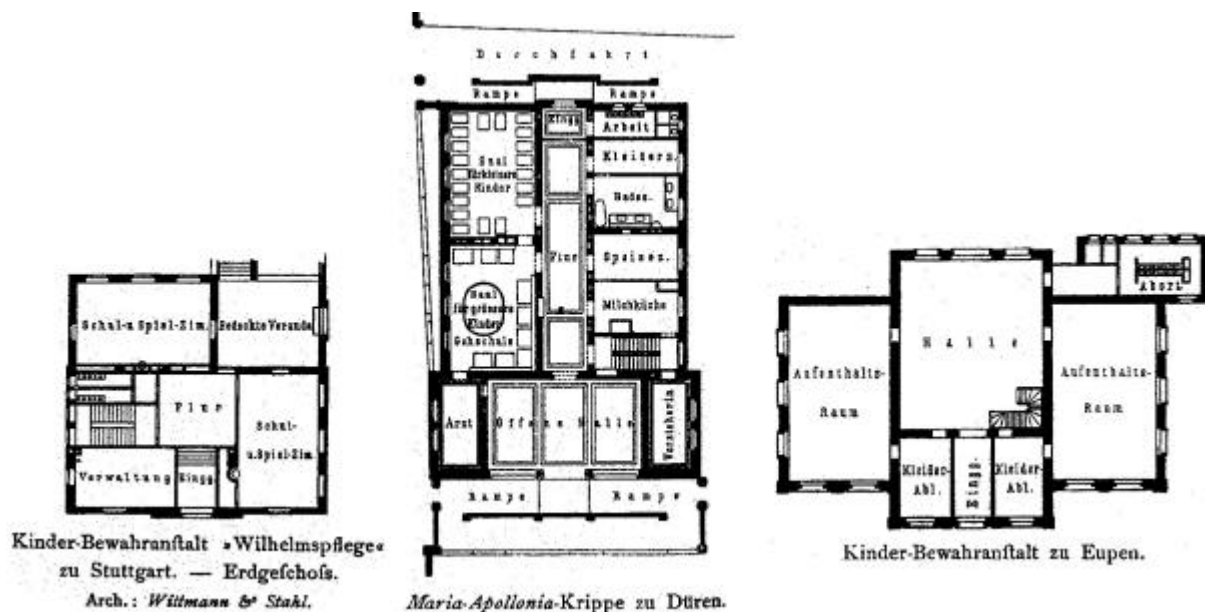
Erdgeschoßgrundriß der Kinderbewahranstalt Wilhelmspflege in Stuttgart³
